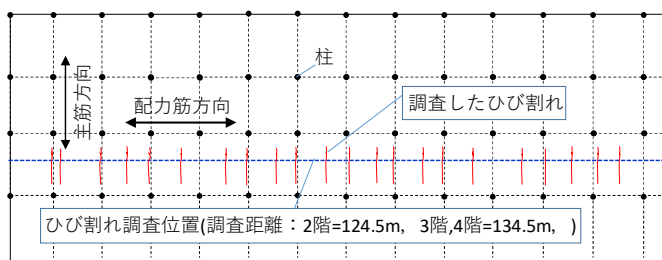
ひび割れ調査方法のイメージ(平面図)
